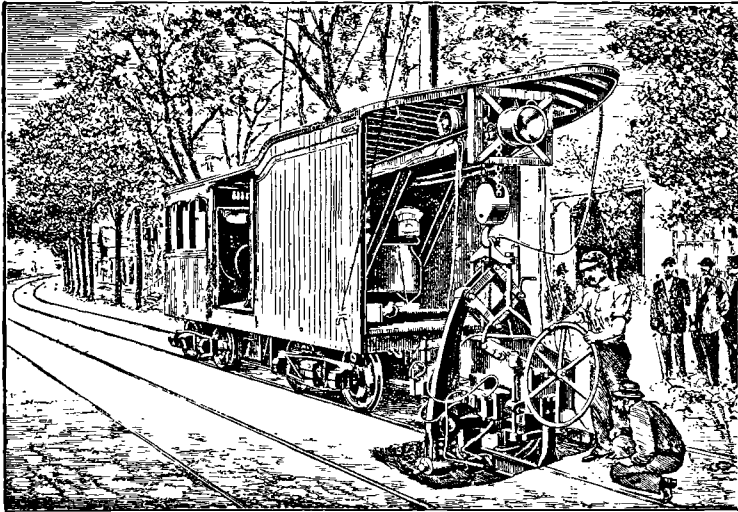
Voiture équipée pour la soudure électrique des rails.
